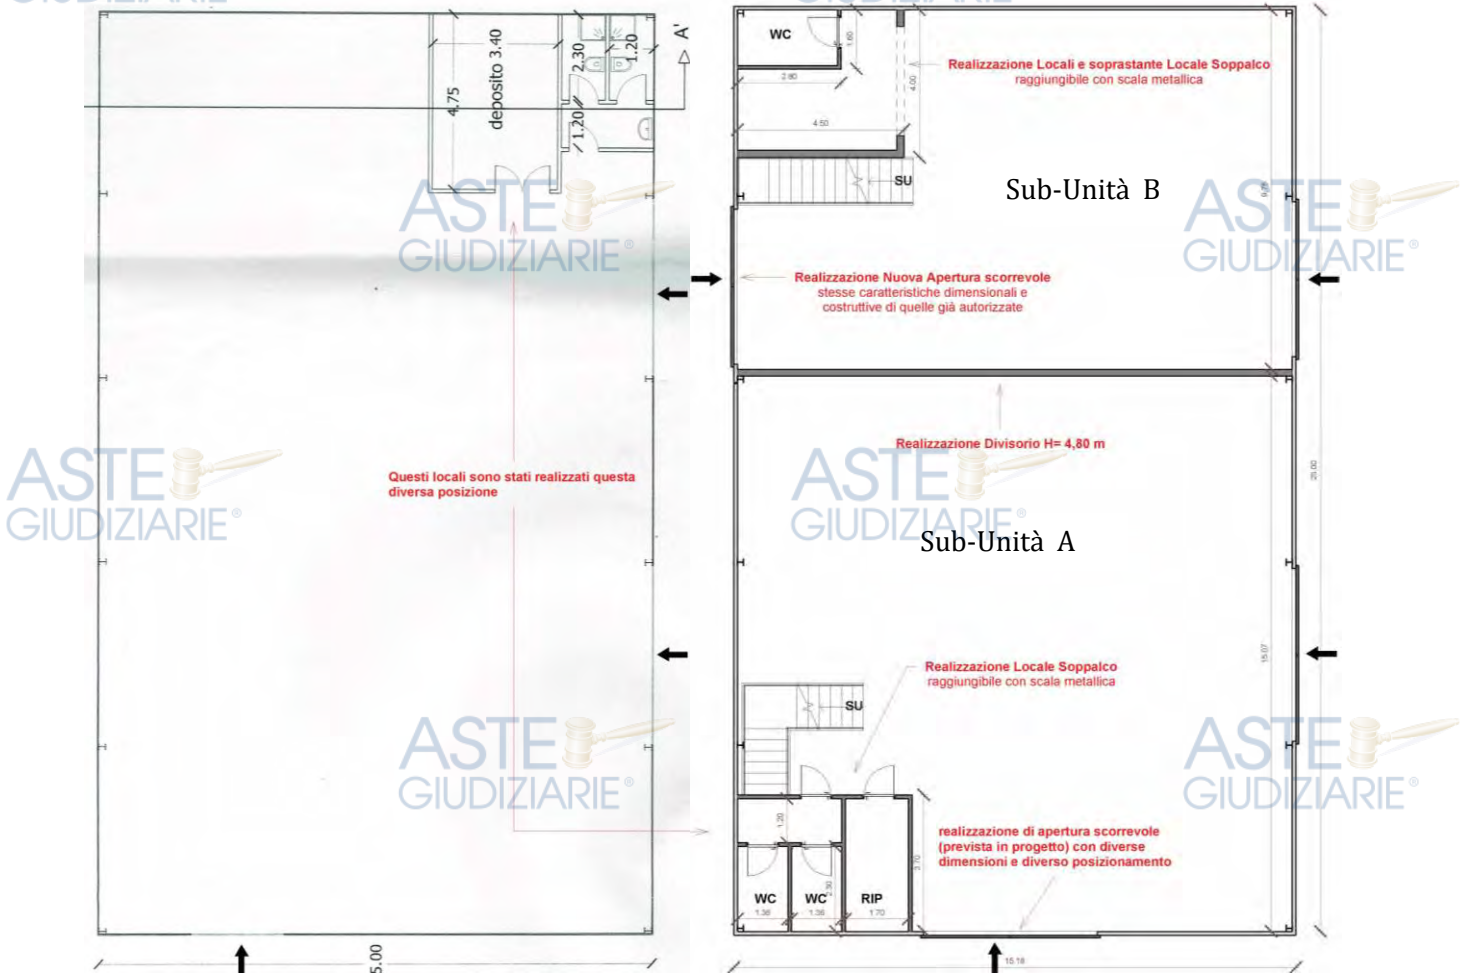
Confronto dello stato di fatto al 23/01/2024 con Planimetria agli atti dell'UTC di S.G. Gemini
